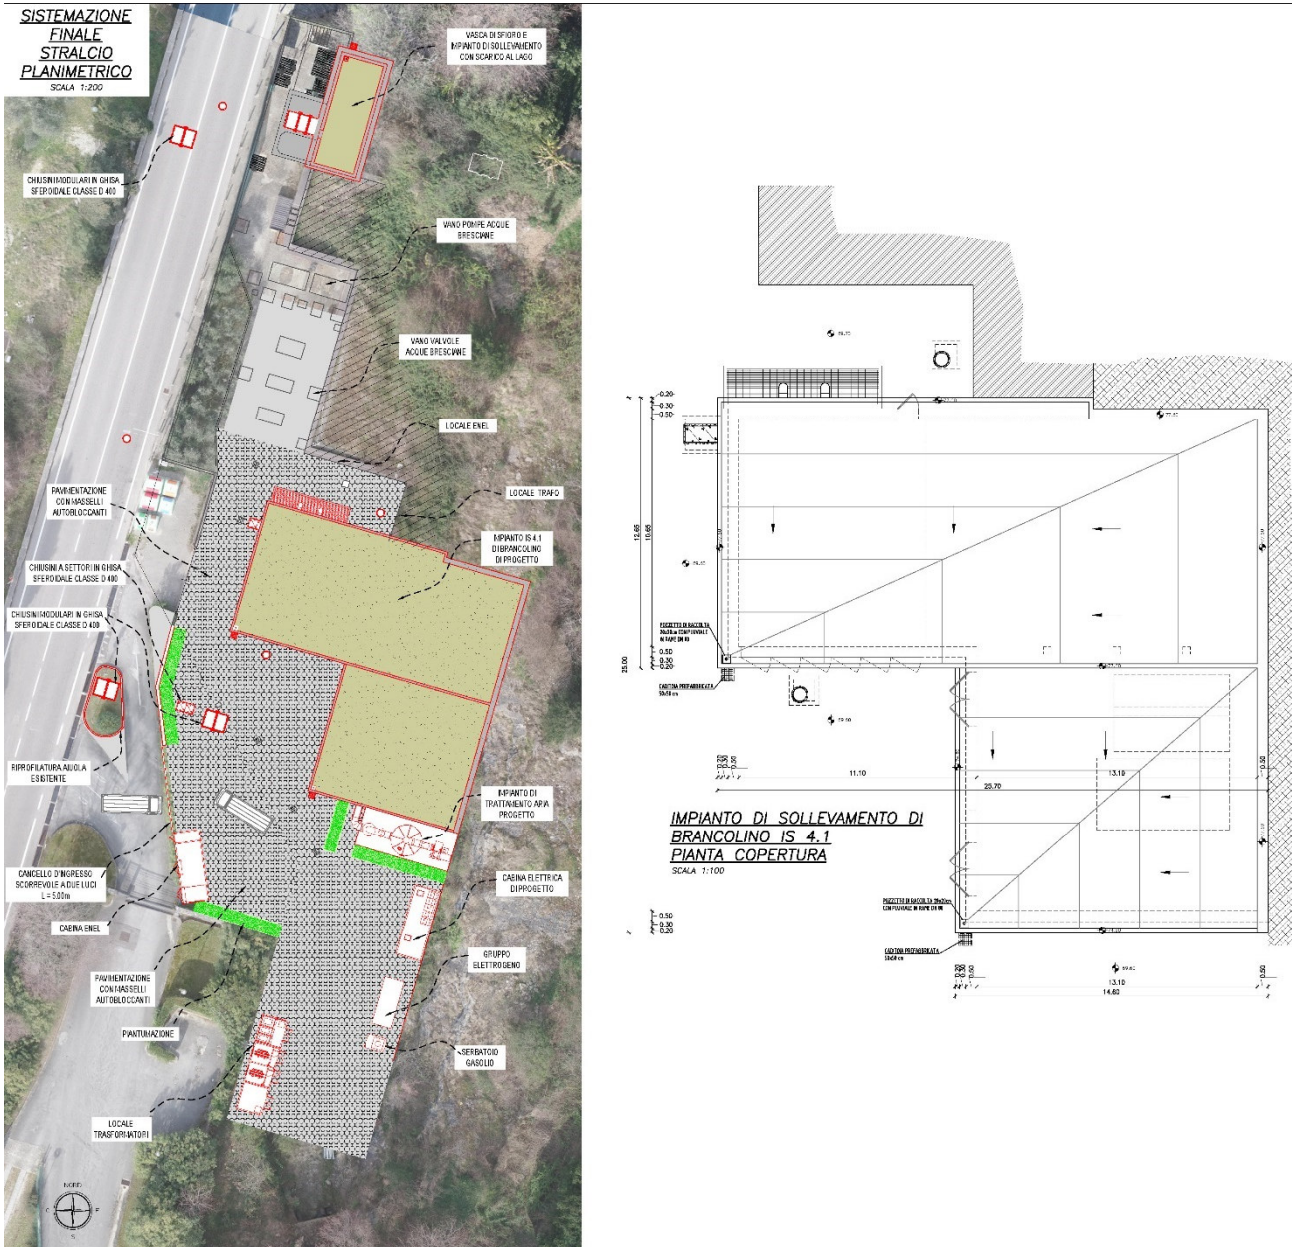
Estratto planimetrico del nuovo impianto di sollevamento e trattamento.
